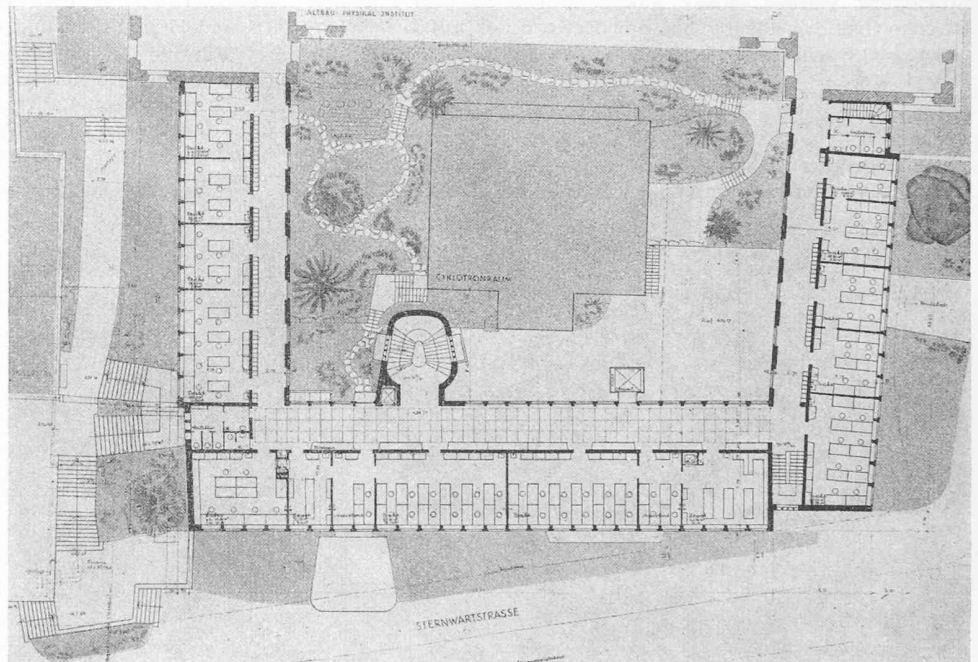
Zweites Obergeschoss, Grundriss 1 : 600
